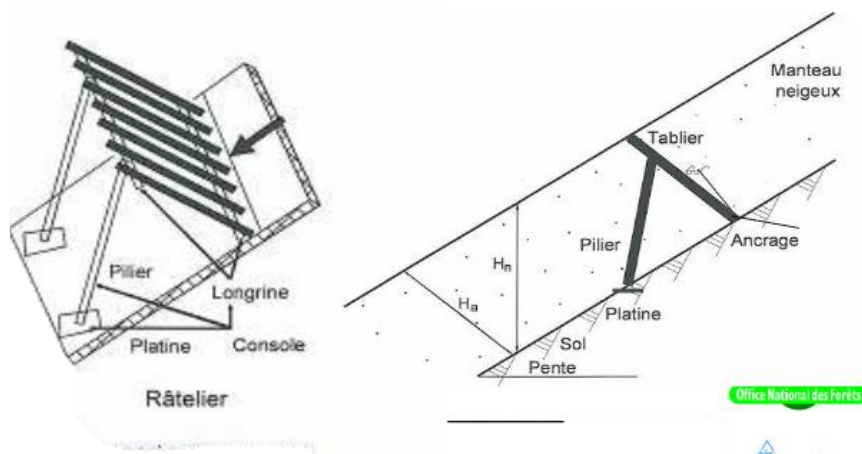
Schéma d'un râtelier (source : CVRH Toulouse, RTM, juin 2013)
